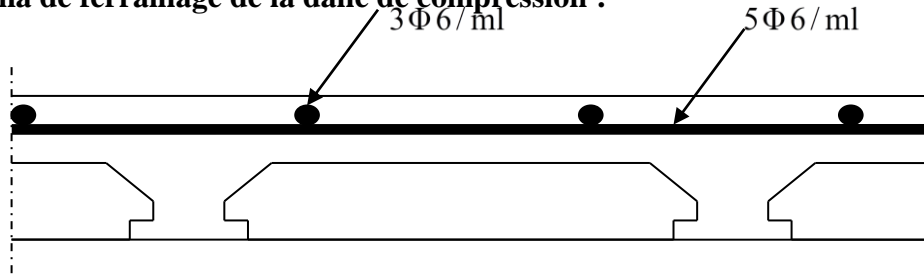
Schéma de ferrailage de la dalle de compression.
